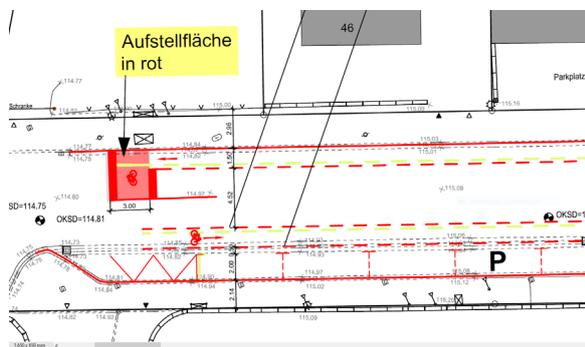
Ausschnitt Planung Ste-Foy-Straße;
